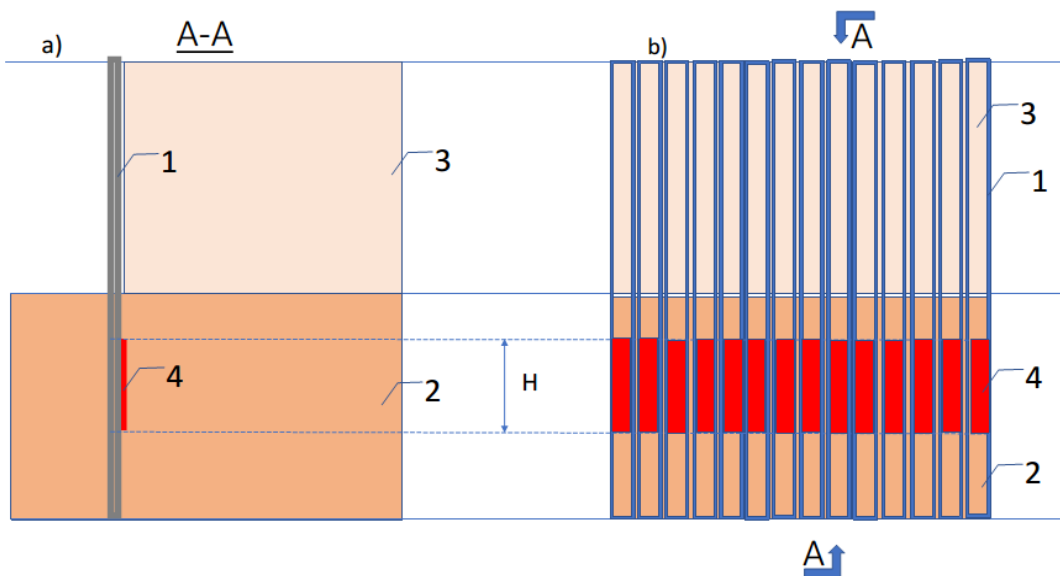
Схема застосування накладок для шпунтових паль з однорідною ґрунтовою основою: а – поперечний переріз; б - вид ззаду на стіну шпунтової палі; 1 – шпунтова стінка; 2 – однорідна ґрунтова основа; 3 – засипка ґрунту; 4 – накладки.
